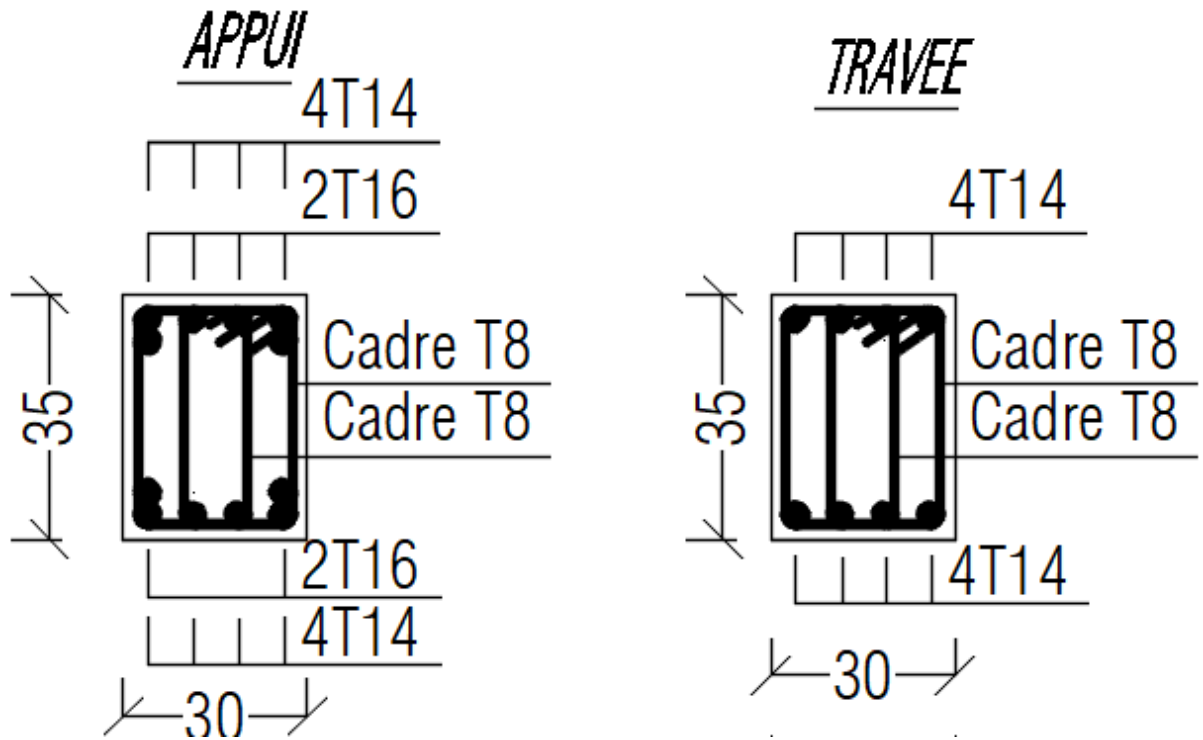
Schéma de ferrailage de poutre principale 30x35.
